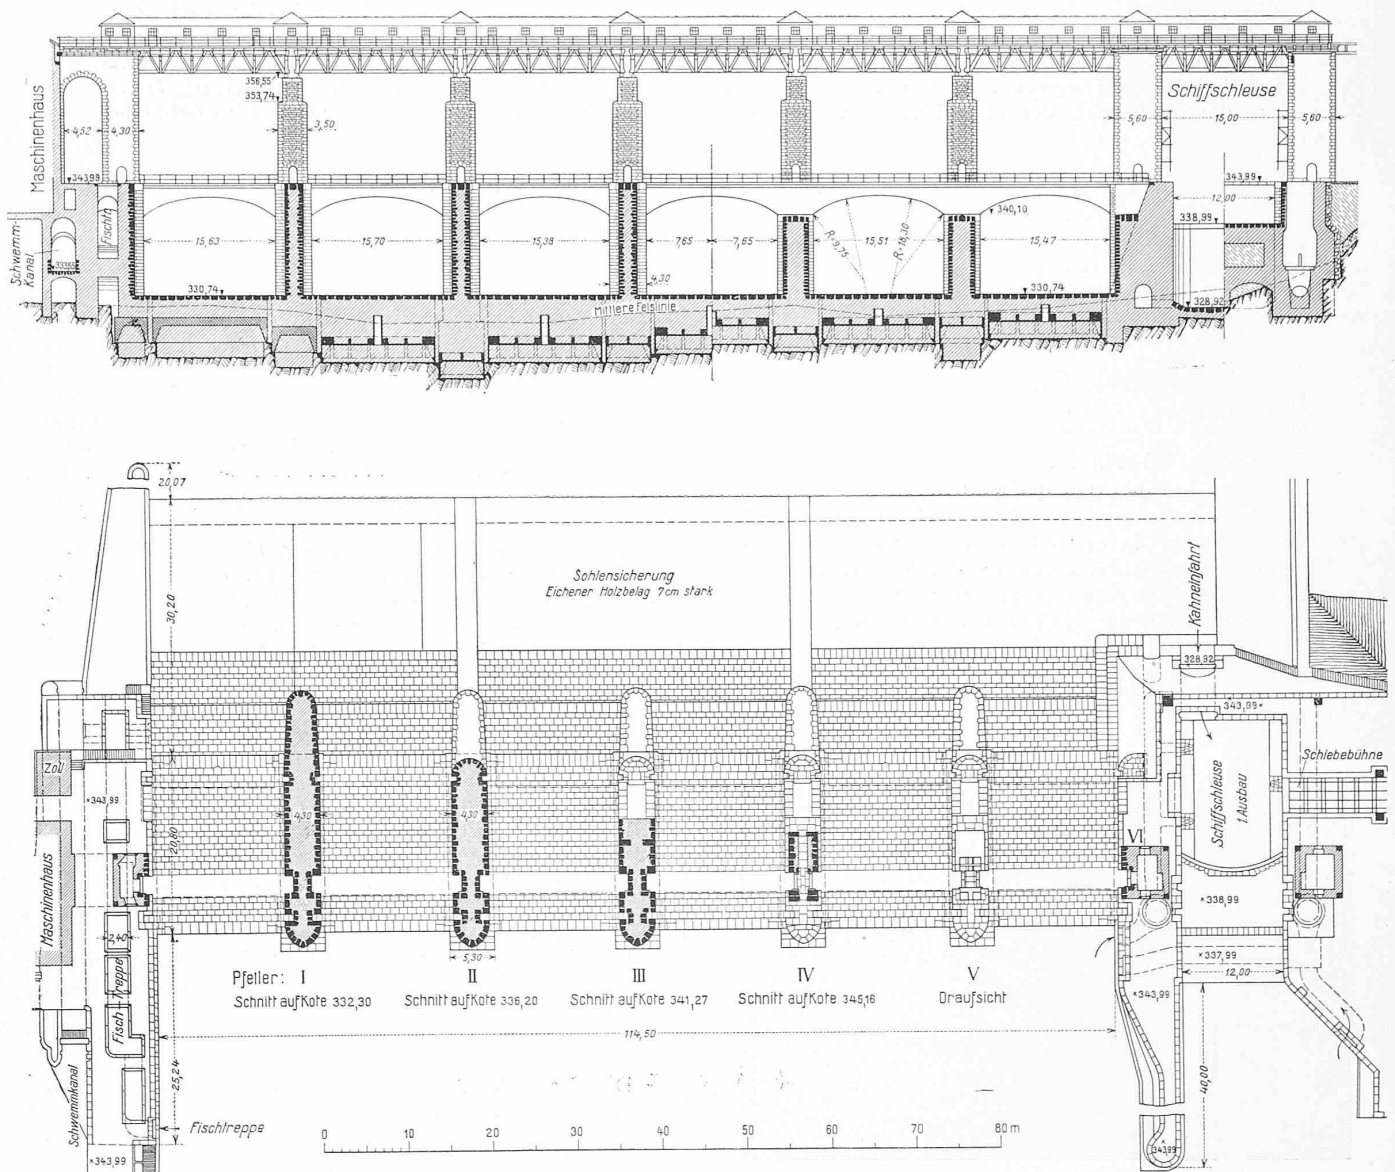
und 17. Grundriss, Horizontal- und Längsschnitte des Stauwehrs des Rheinkraftwerks Eglisau. — Masstab 1 : 800. (Querschnitt siehe Seite 48.)
